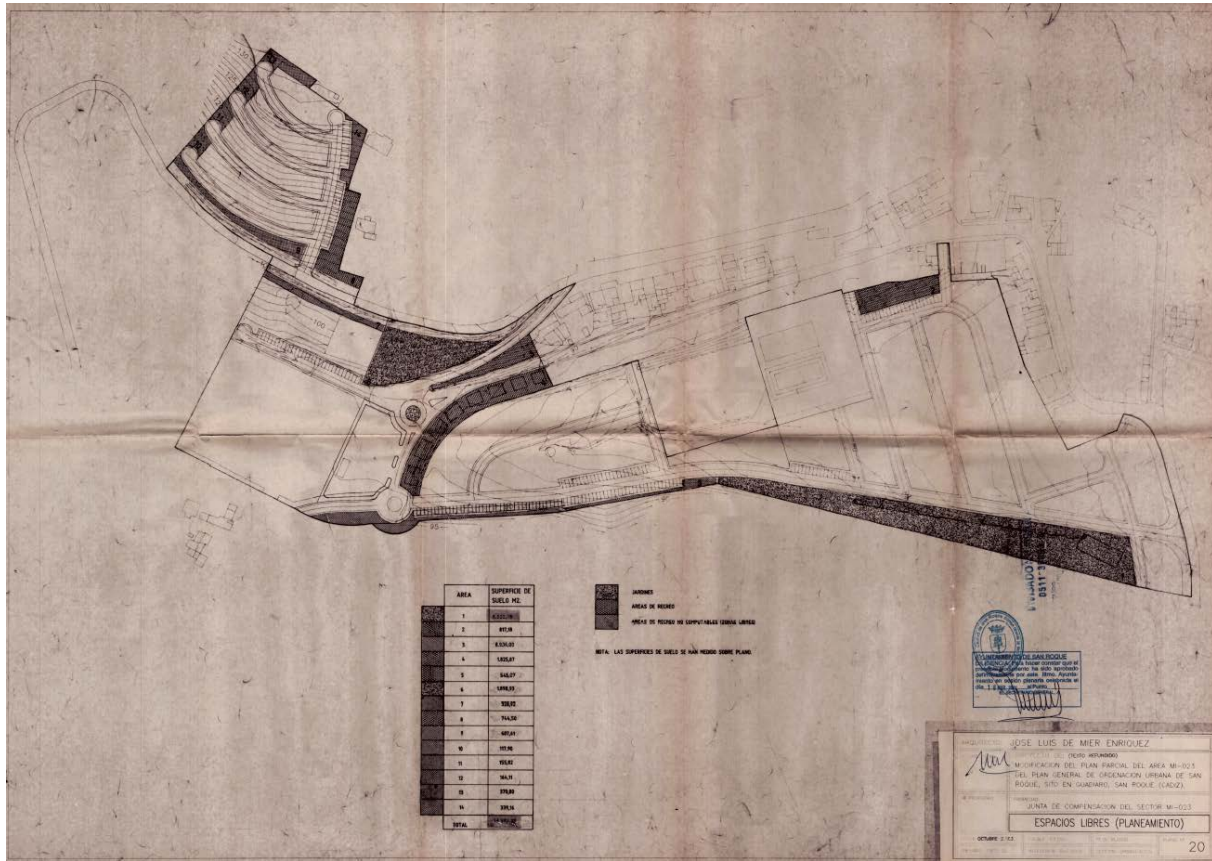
MODIFICACION DE PLAN PARCIAL DE AREA MI-23 .PLANO 20 ORDENACION ESPACIOS LIBRE.16/03/2004
